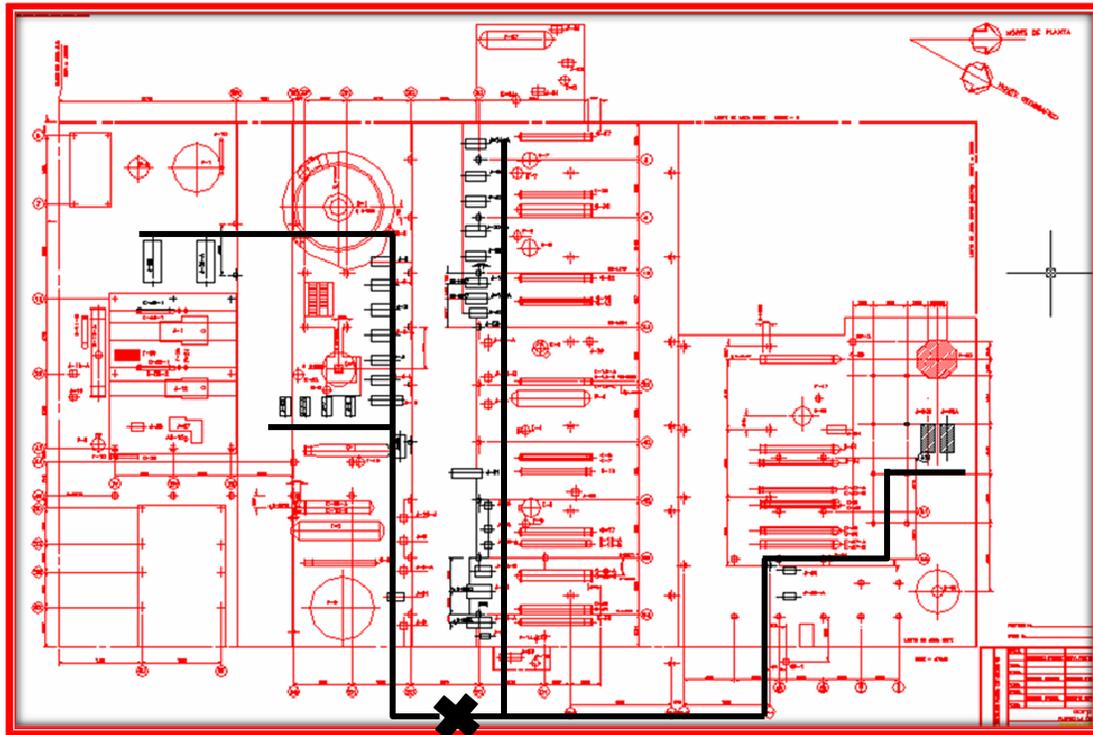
Plano de la planta de FCC con ubicación de la consola de generación en planta Y ruda decidida para el paso de la red de tubería principal.
